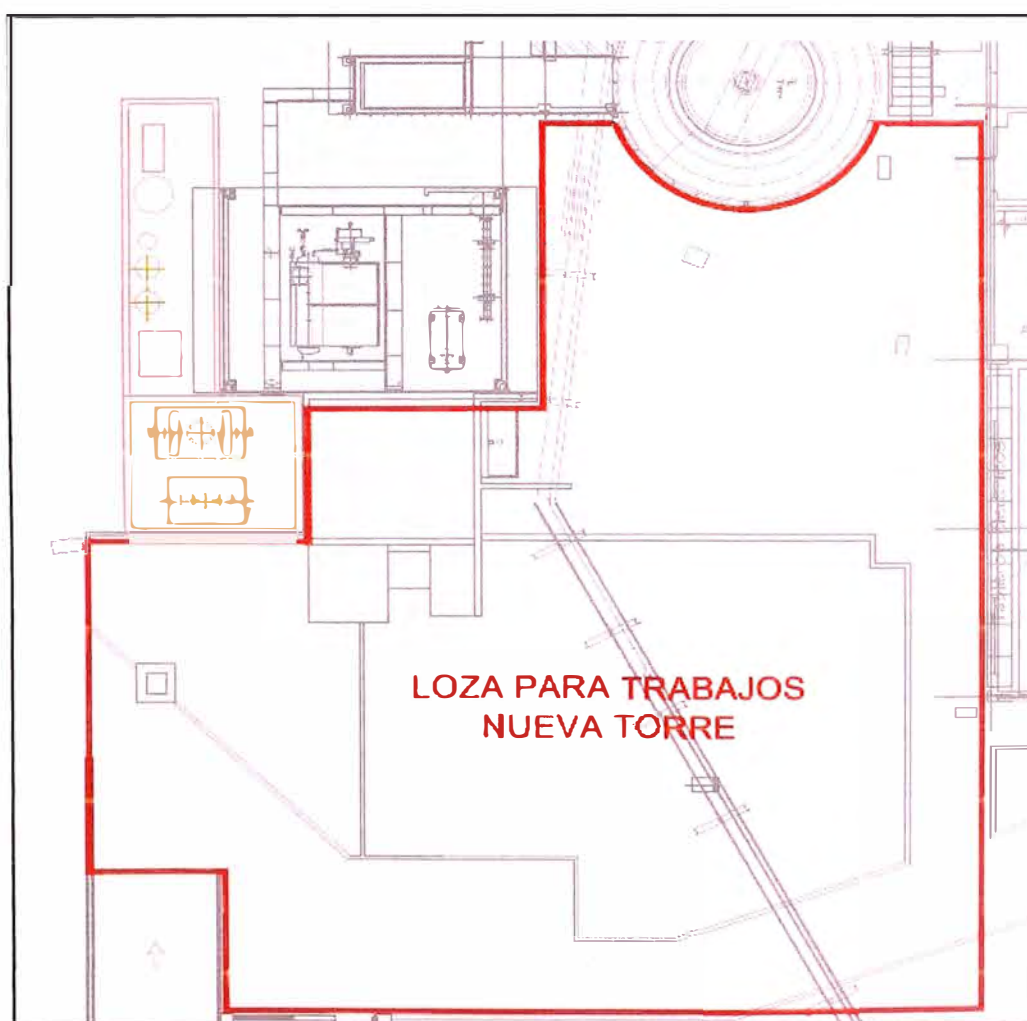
Vista de Planta de Tendido de tuberías actual
